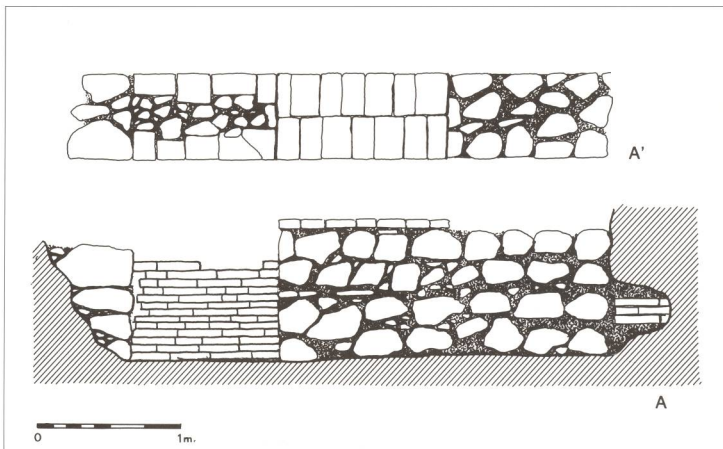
Singilia Barba. Muro realizado en piedras y argamasa, con pilares e hilada de nivelación en ladrillo.
